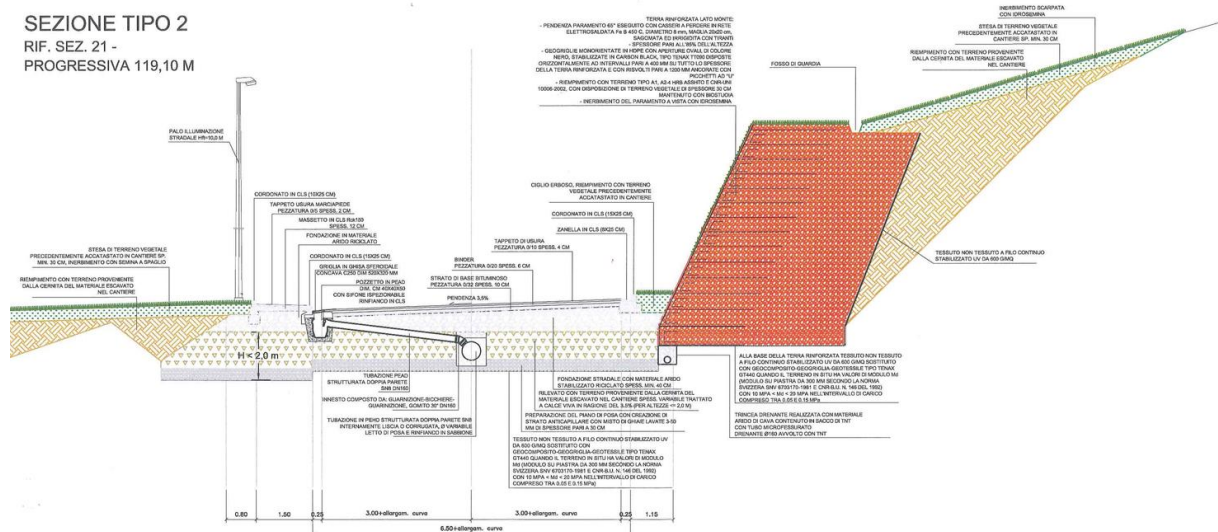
SEZIONE TIPO DI PROGETTO CON TERRA RINFORZATA A MONTE
